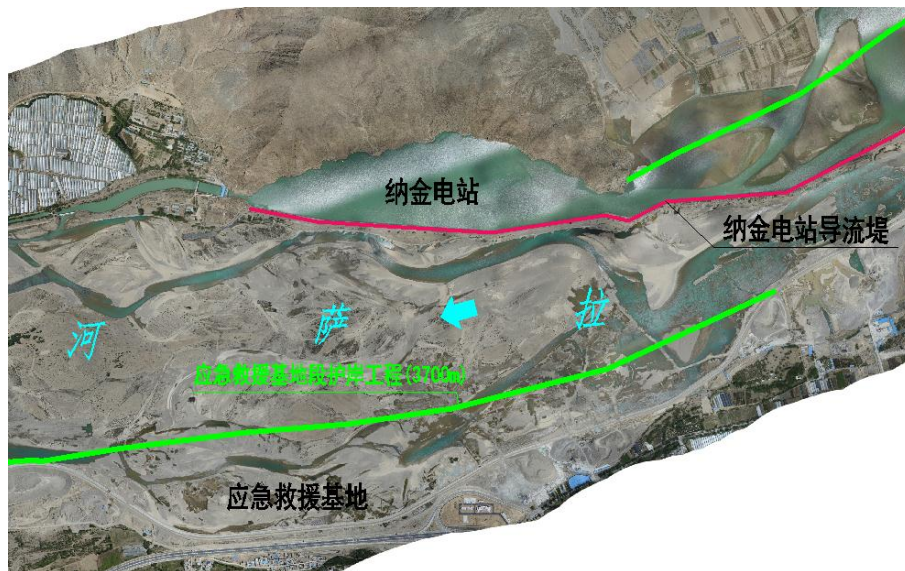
应急救援基地段护岸工程平面布置示意图
